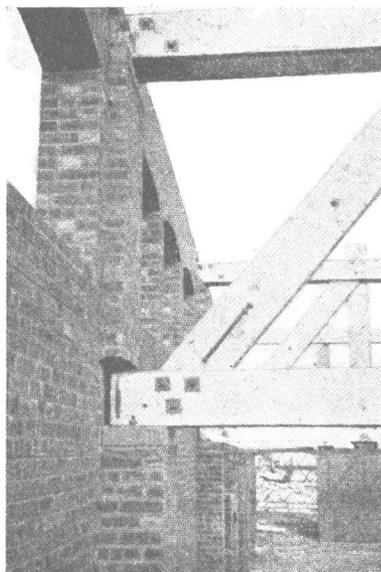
Las extremidades de las armazones transversales apoyan en las paredes sobre pilastras formadas con el mismo ladrillo de las paredes. Las extremidades se sujetan por medio de pernos, uno de los cuales aparece en el grabado.
